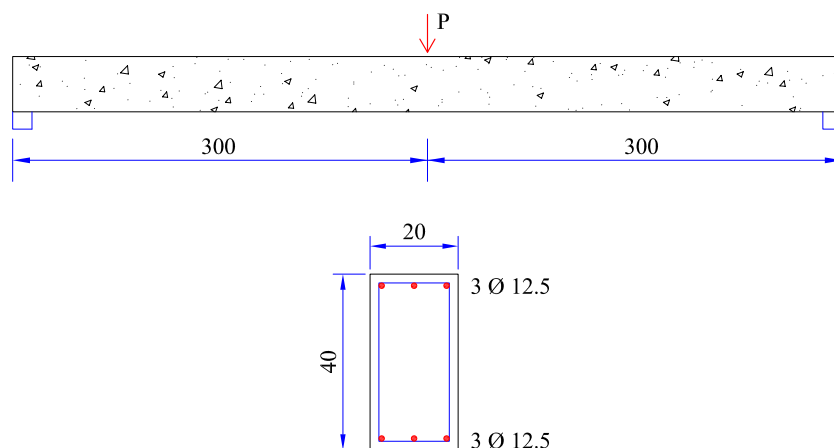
Detalhes da geometria, carregamento e armaduras da viga de Jarek et al. (2011).
